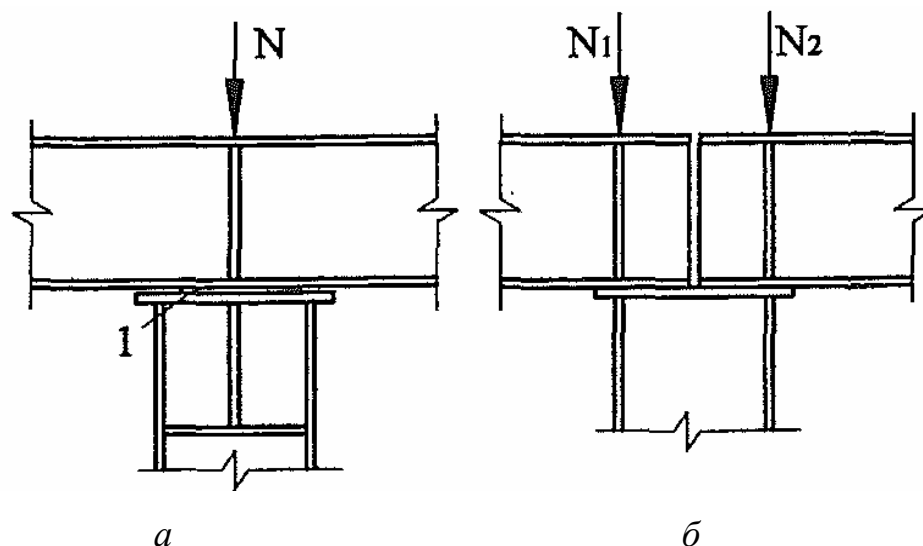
Варіанти передачі навантаження від балок: а – через підкладки; б – через внутрішні опорні ребра; 1 – підкладка
